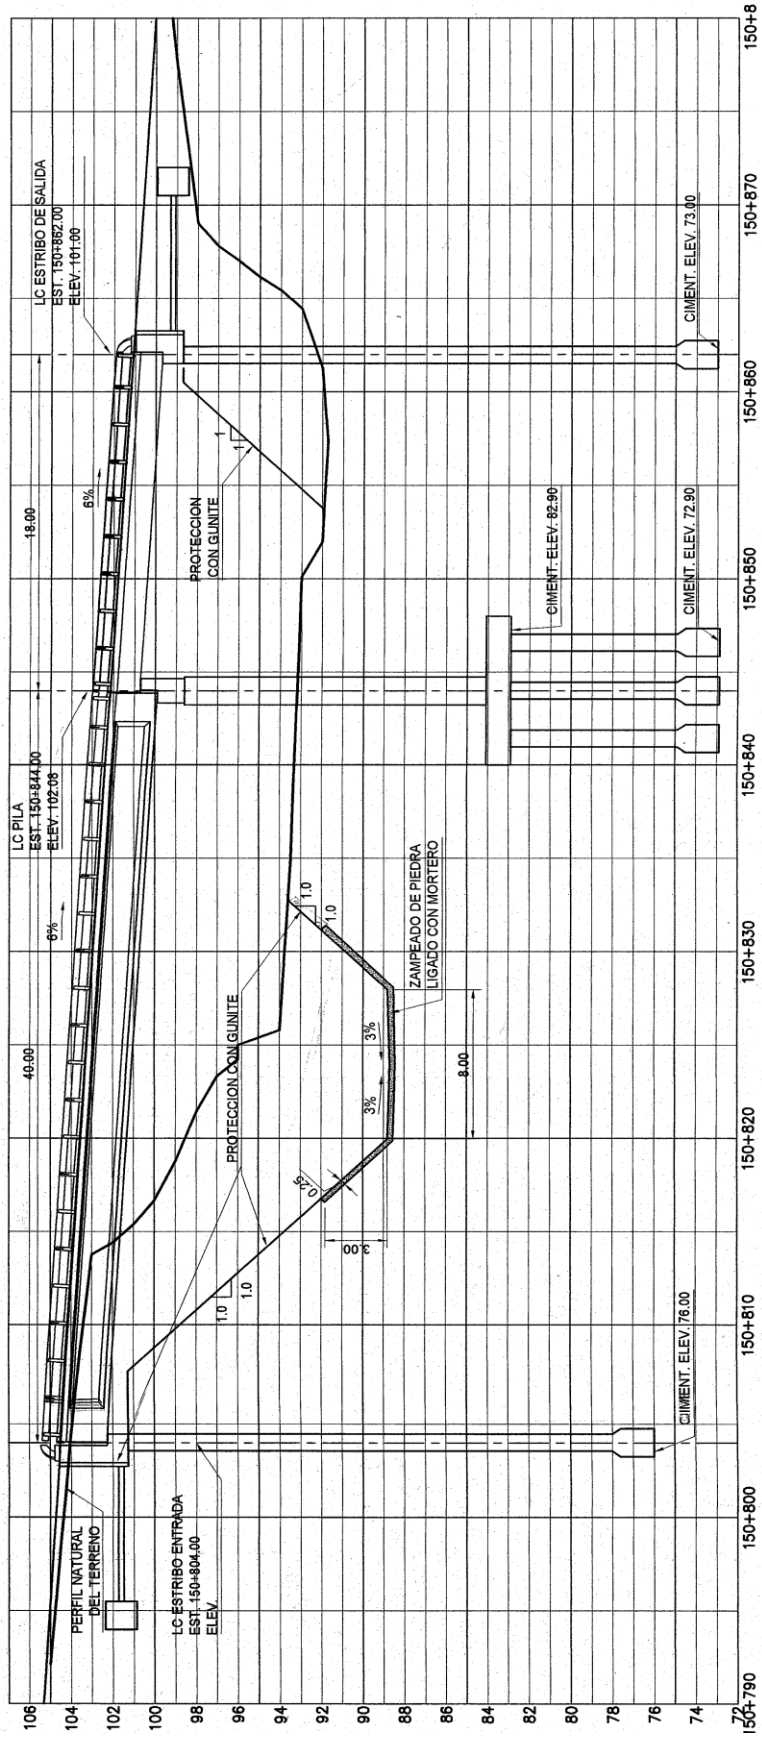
VISTA EN PLANTA EN DONDE SE PUEDE APRECIAR LA TOPOGRAFÍA, ASÍ COMO LA LOCALIZACIÓN Y ARREGLO DE LOS ESTRIBOS Y DE LA PILA.
